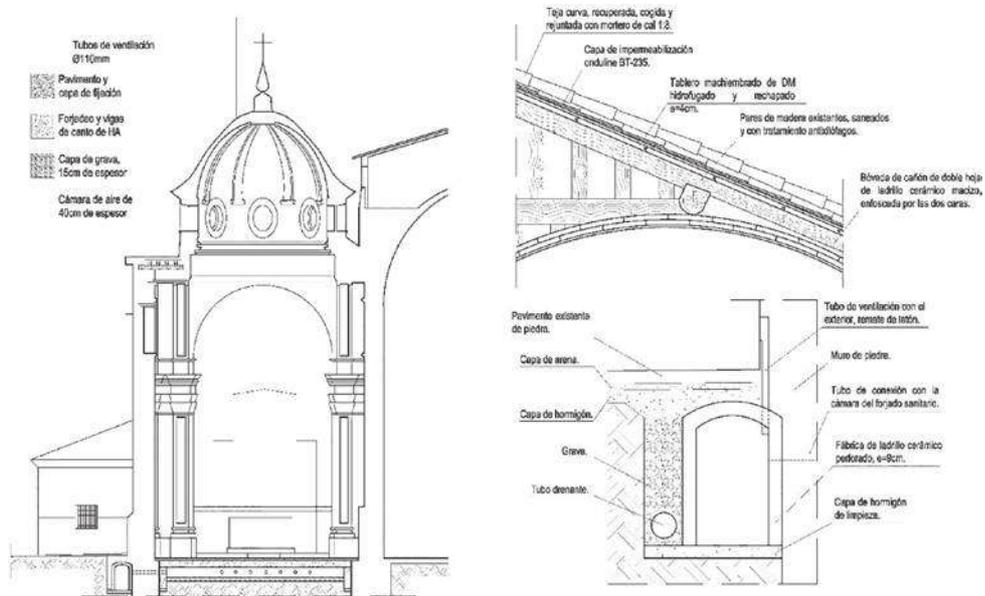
Sección transversal Capilla de la Comunión y detalle de propuestas.
